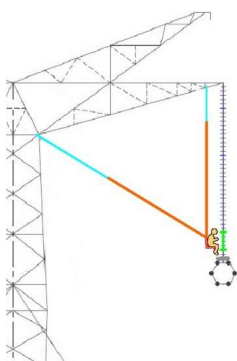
Arranjo submetido ao ensaio de tração para conjunto de 320 kN
